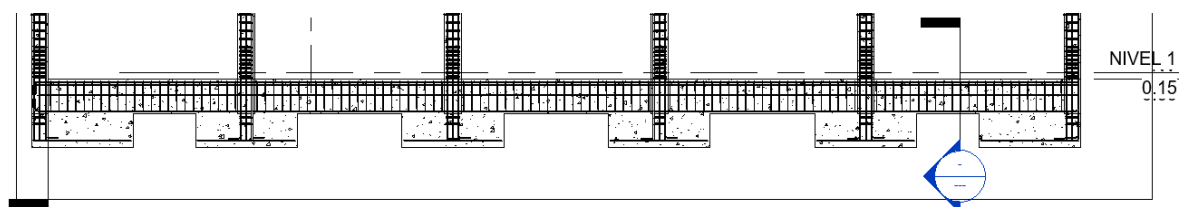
Vista Corte de distribución de acero en Viga de Cimentación en Proyecto
